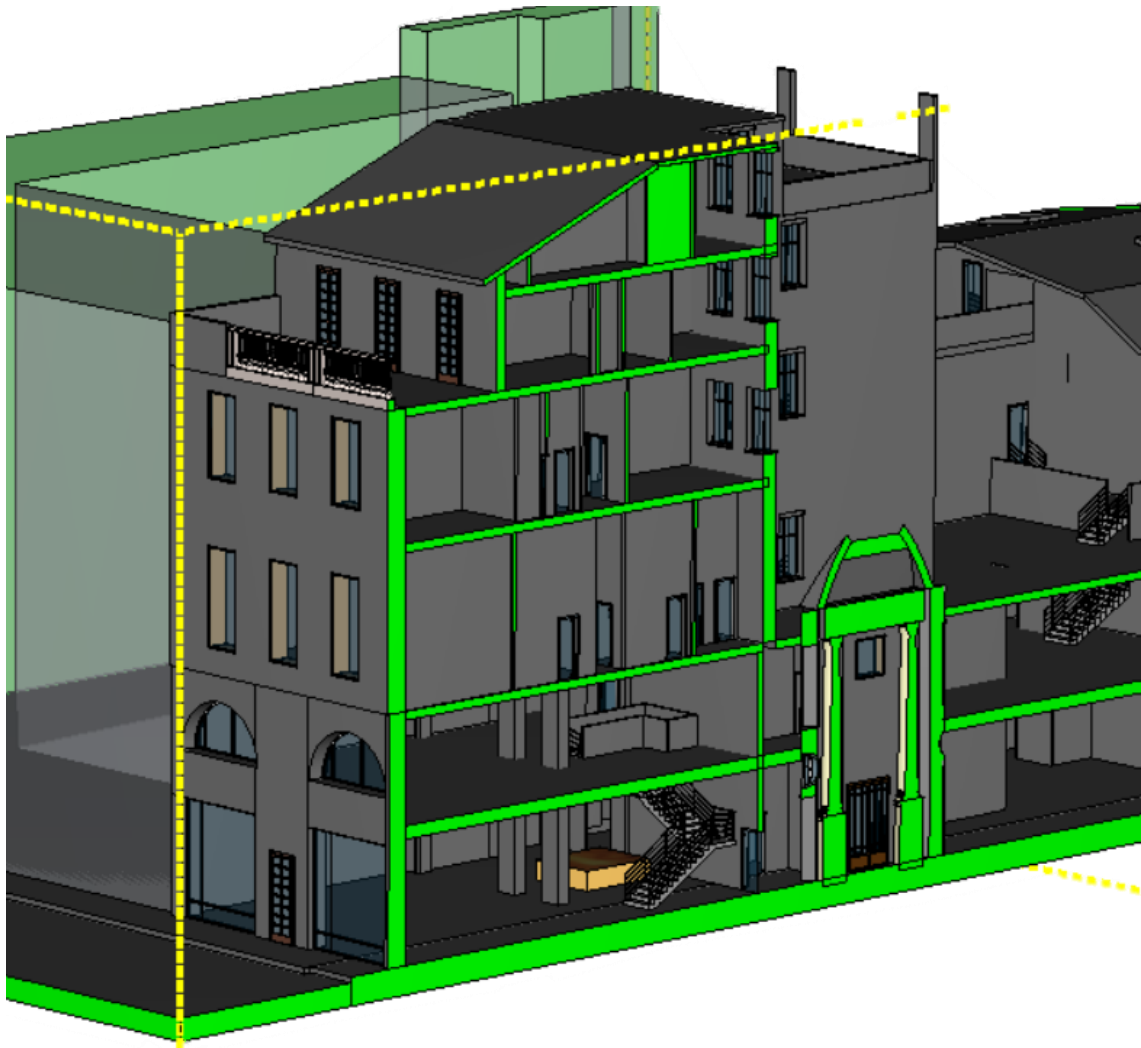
Posizione focolare in sezione (Scenario1-Pyrosim)
